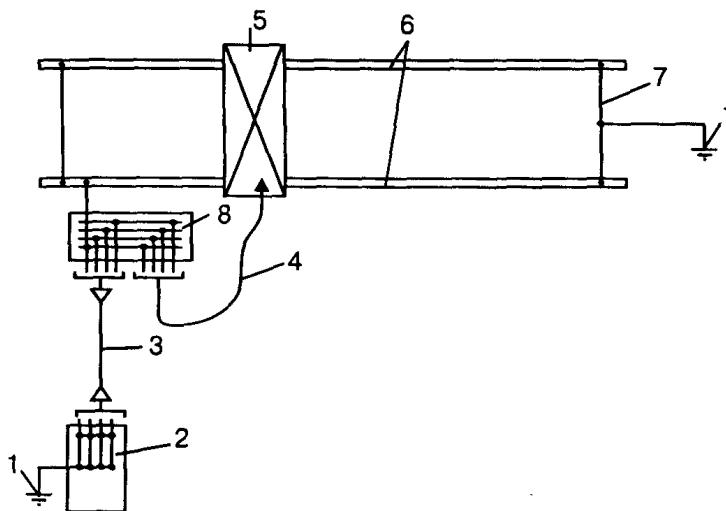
Схема заземления крана, установленного на открытом воздухе
